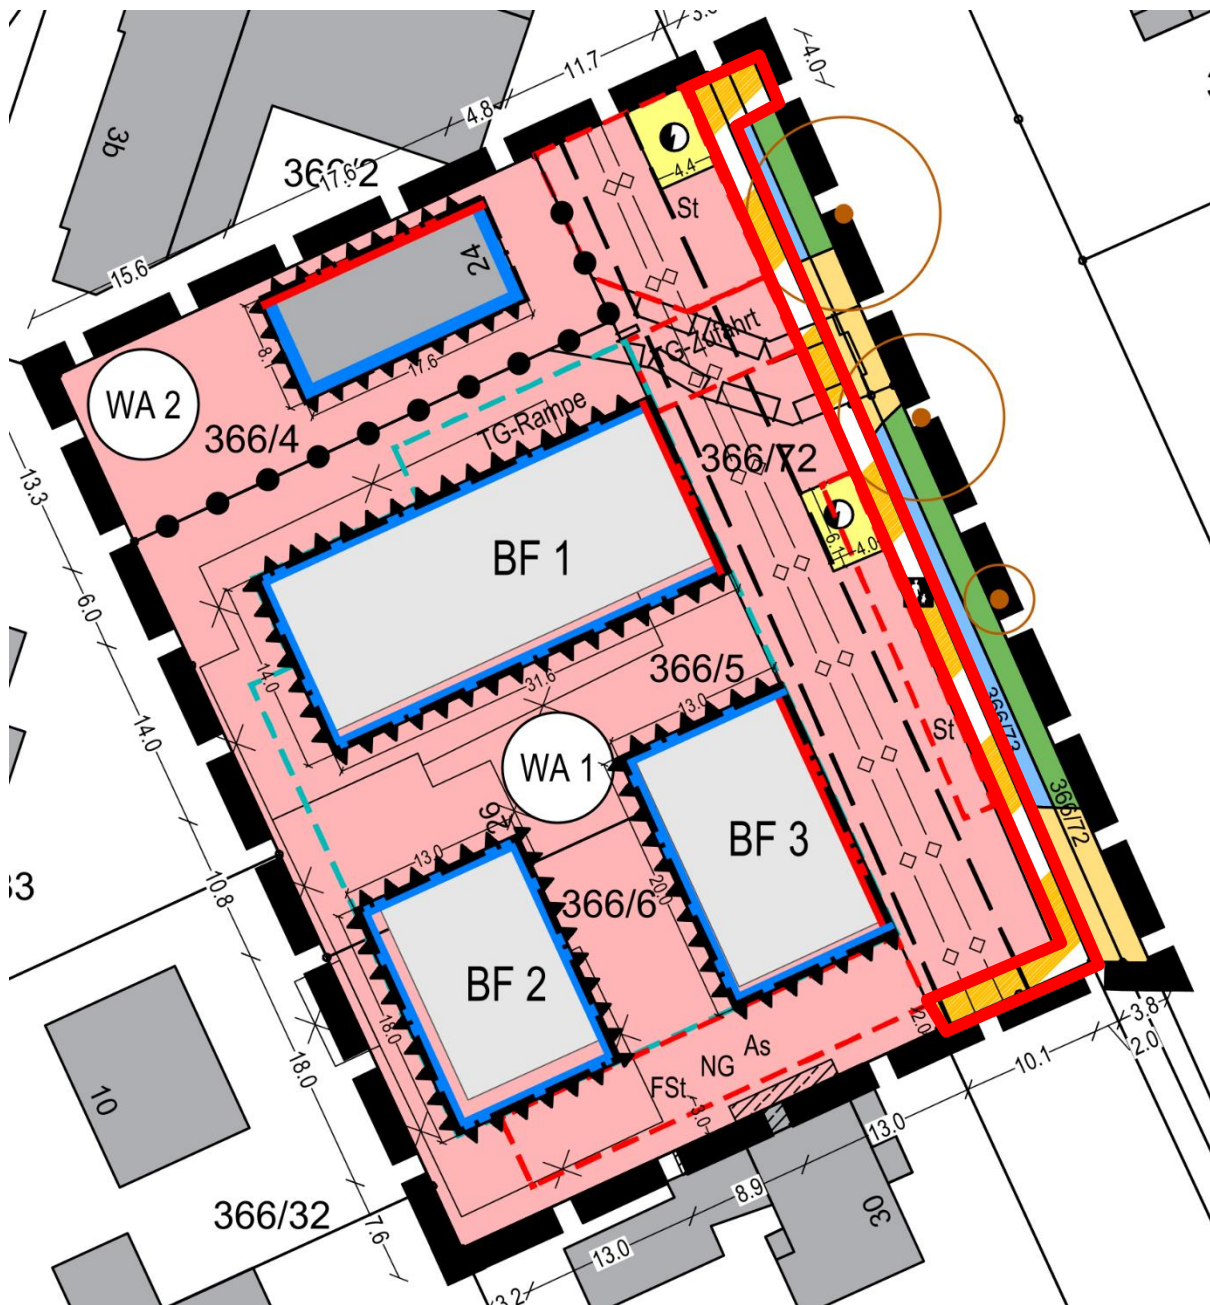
Auszug Bebauungsplan mit Geh- und Radweg (rot umrandet)
